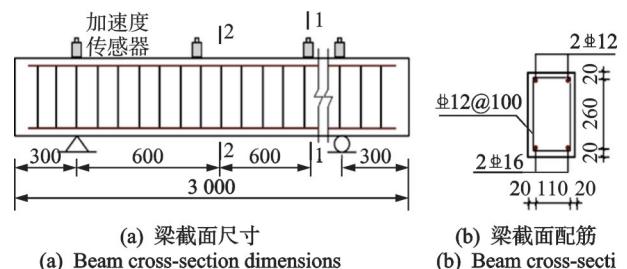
锈蚀钢筋混凝土梁构件(单位:mm)
